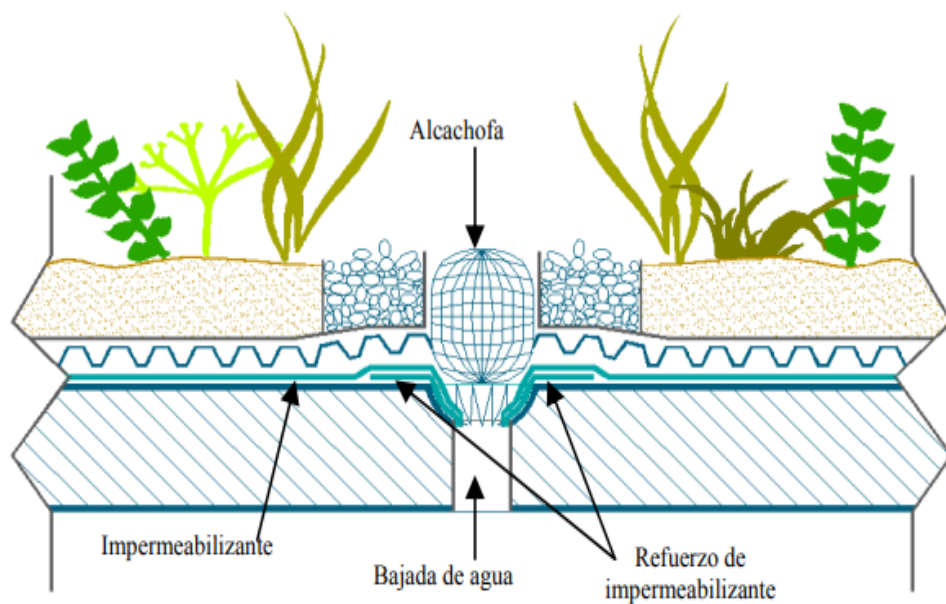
Encuentro cubierta verde con bajada de agua www.ordenjuridico.gob.mx
